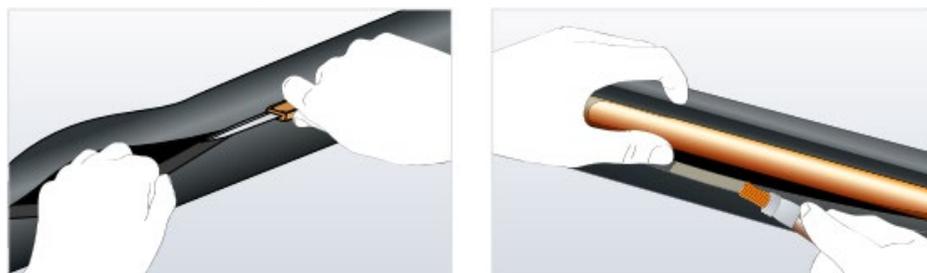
Fendre l'isolant tubulaire, le poser autour de la conduite et appliquer la colle du système
